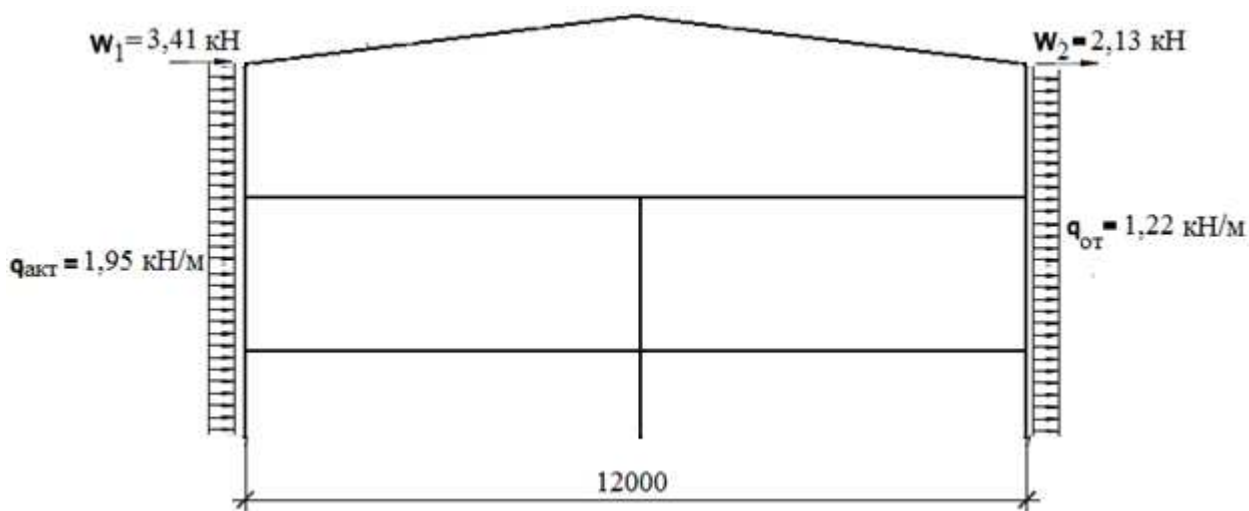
Схема нагружения от ветровой нагрузки слева здания
